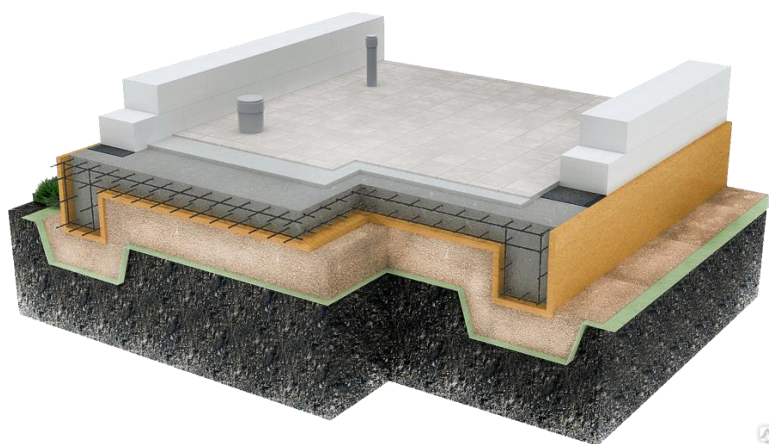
Схема фундаментной плиты с нижними ребрами [8]
